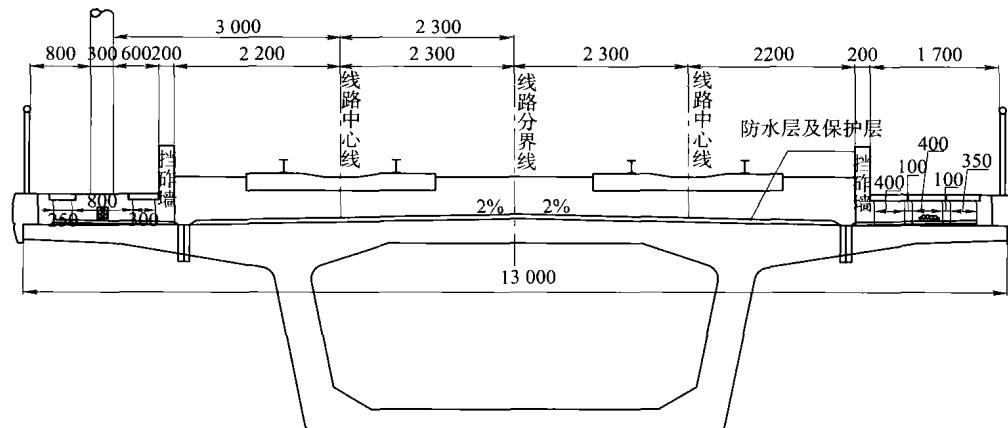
客货混运高速铁路箱形梁横断面示意(单位:mm)
